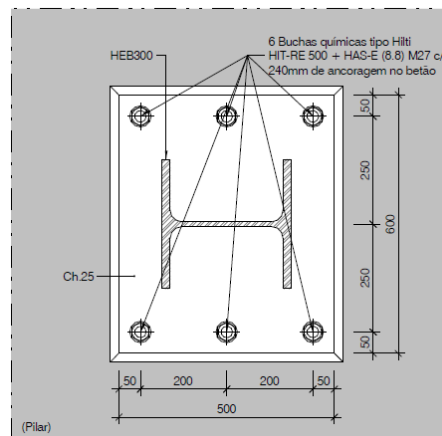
Pormenor em planta da ligação a verificar, associada ao método III. [SE2P]
